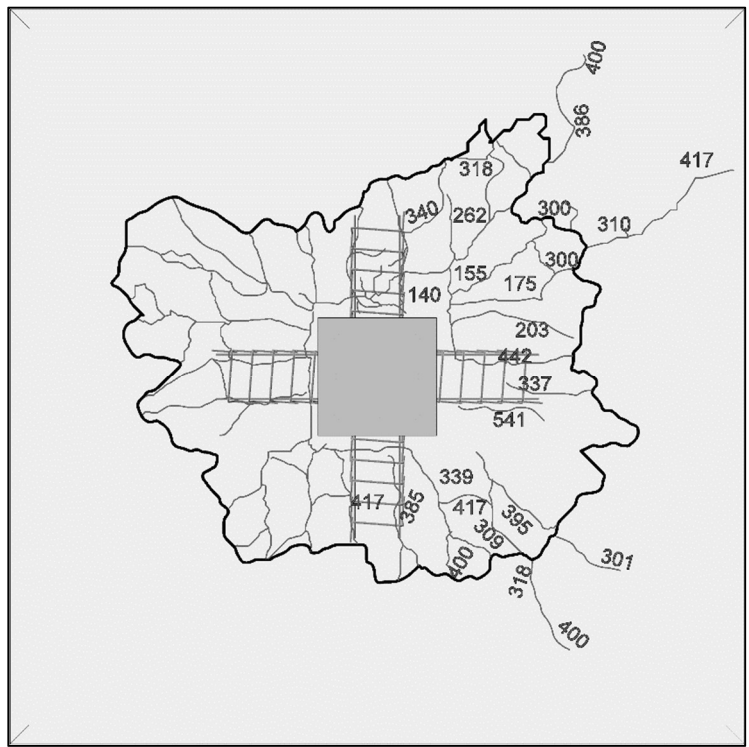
Mapa de fissuração da laje CFA
